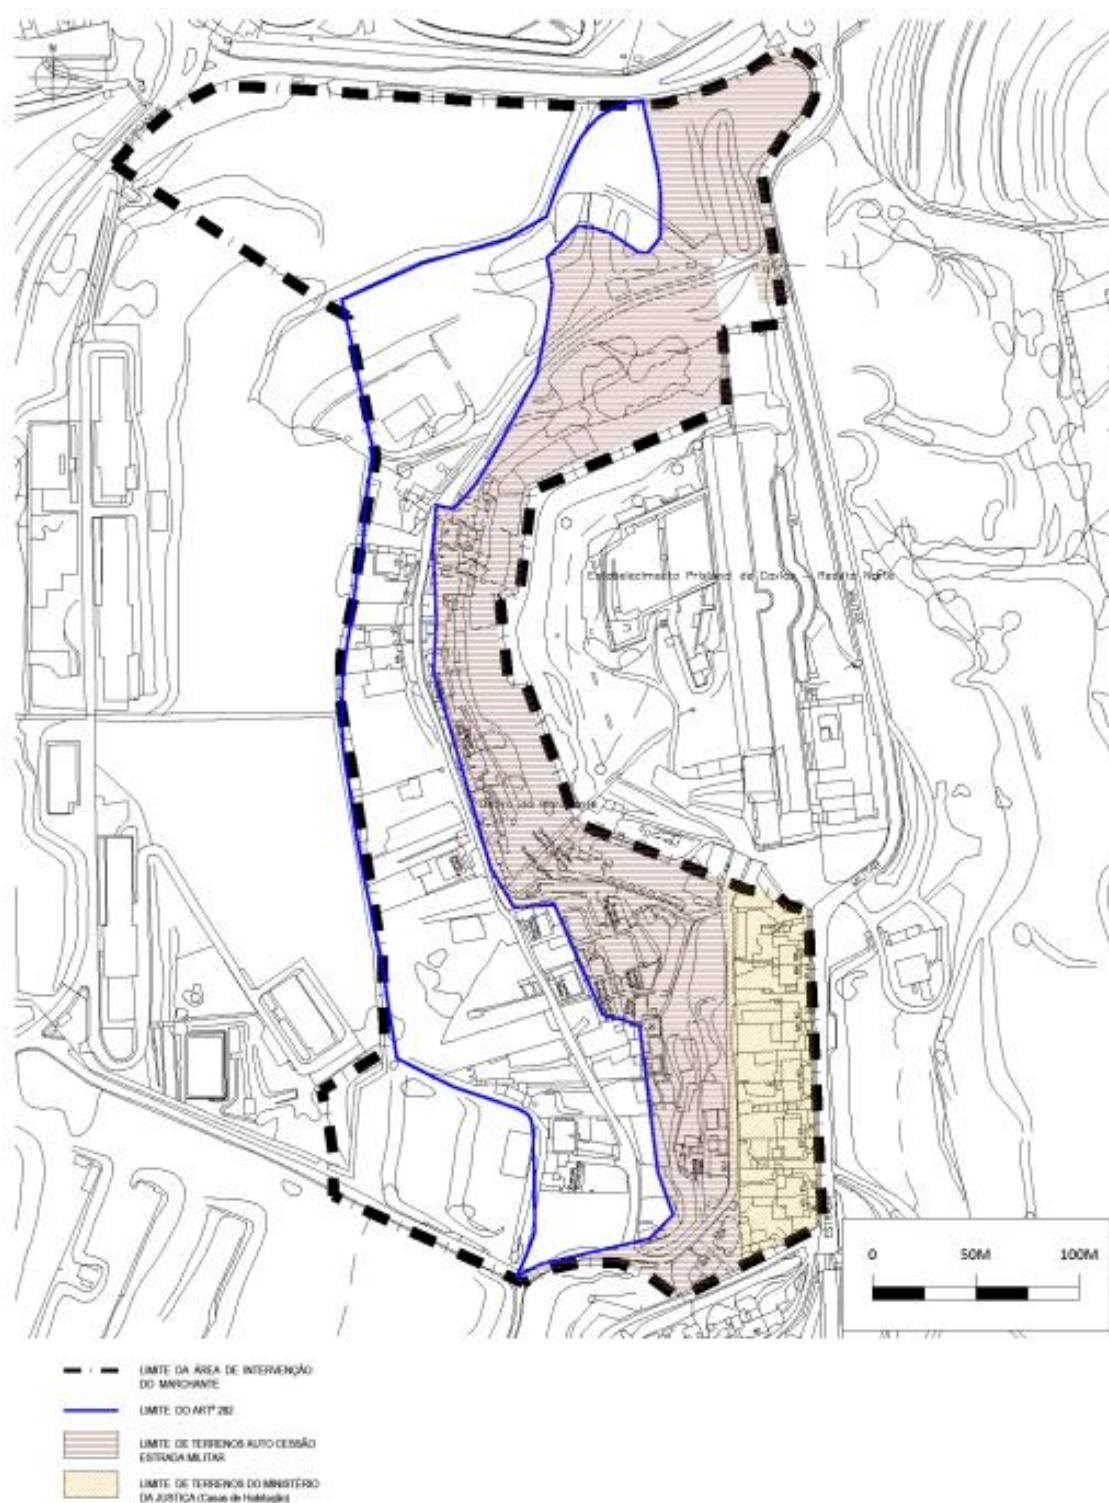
Planta de Estudo prévio do bairro do Marchante. Fonte: CMO/DPE
